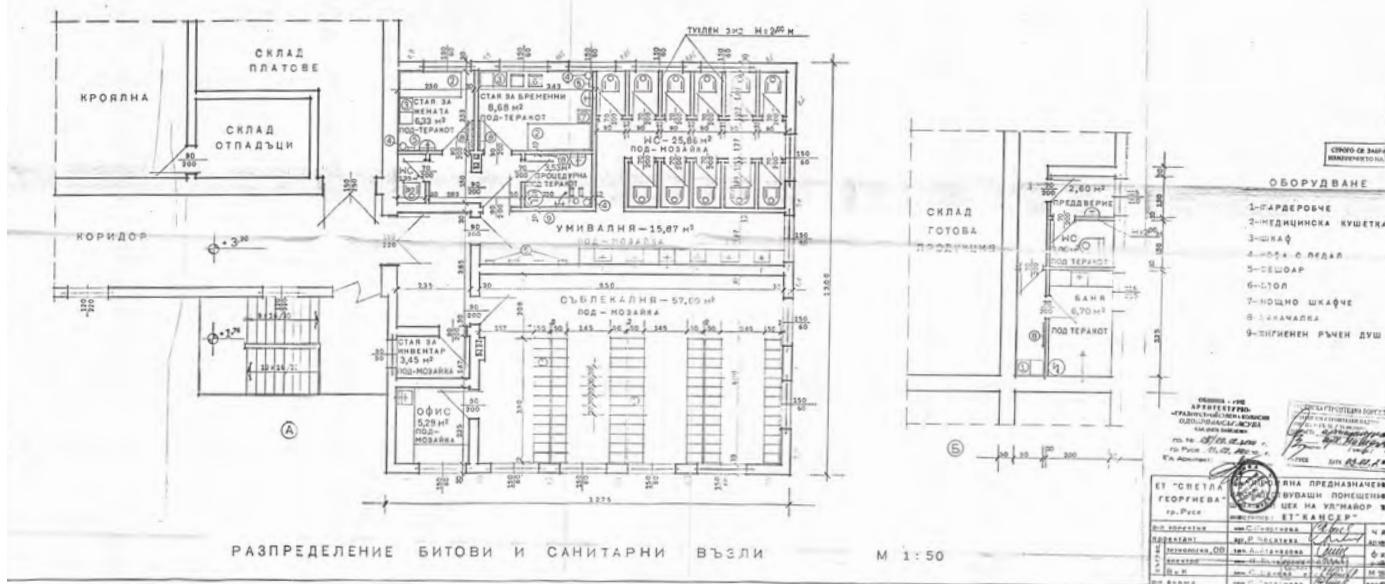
Detail Grundriss Erdgeschoss Kaserne, Pläne aus dem Kataster in Russe
